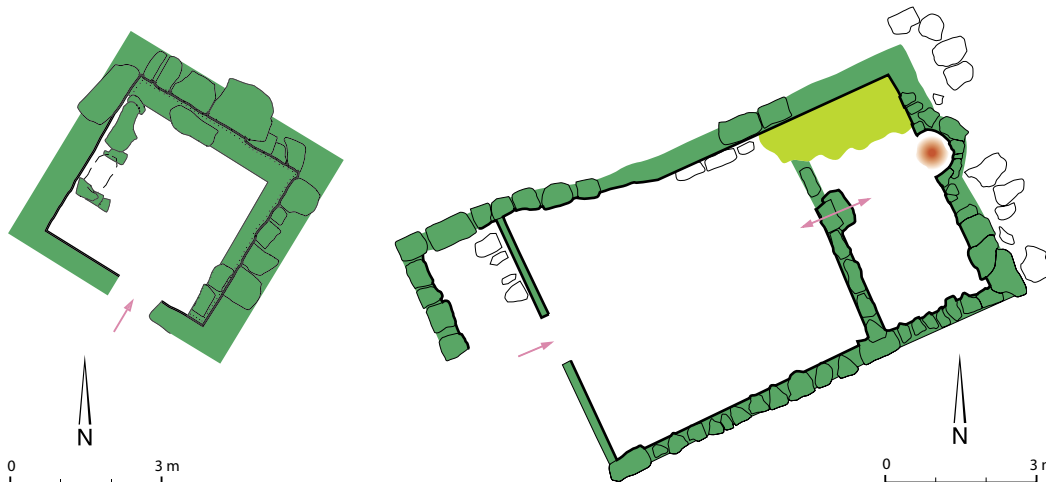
Hasliberg, Entlibüsch 1, Struktur 1. Gebäudegrundriss mit Ablagebank entlang der Mauern (grün).
